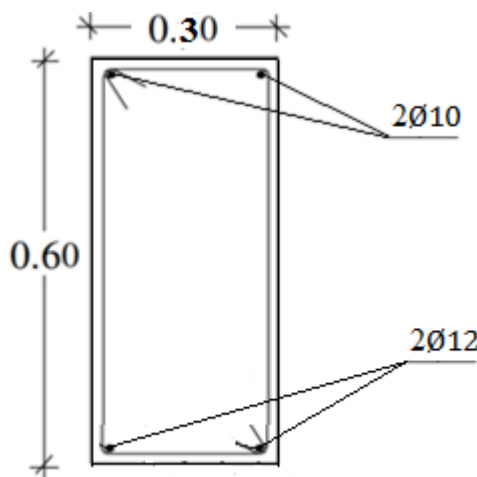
Armadura das Vigas segundo *eixo y* (Corte Transversal)
